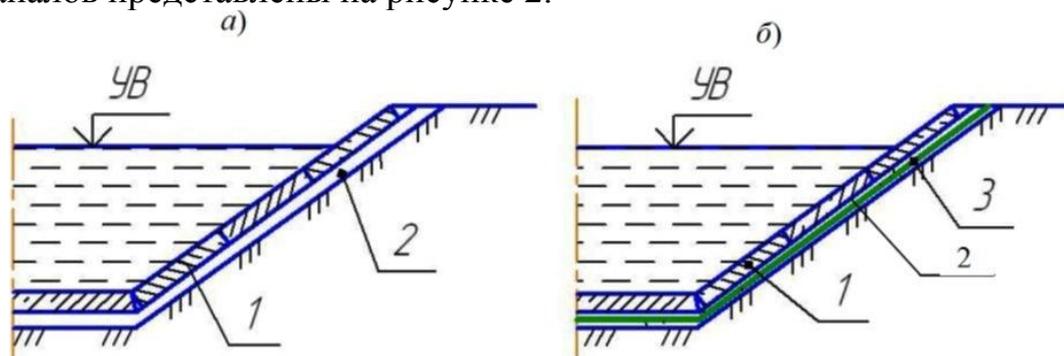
Конструкции бетонных и бетонопленочных противofильтрационных облицовок оросительных каналов: а) – бетонные и железобетонные облицовки; б) – бетонопленочные; 1 – бетонное покрытие; 2 – подстилающий слой; 3 – пленочный противofильтрационный экран.
